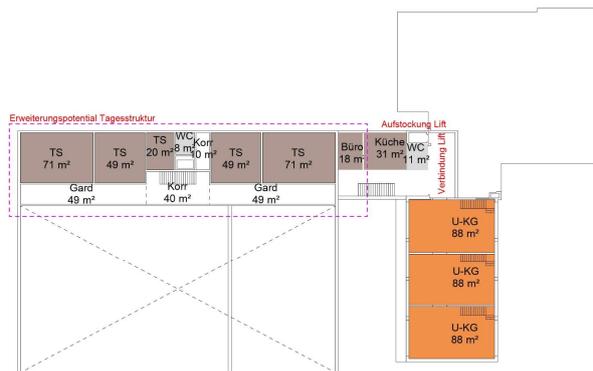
2. Obergeschoss Turnhalle, Variante «gelb»
